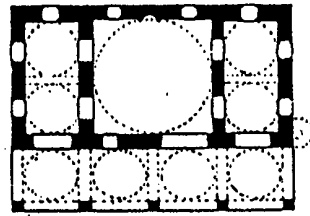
مسقط أفقي للجامع المجاهدي بالموصل
